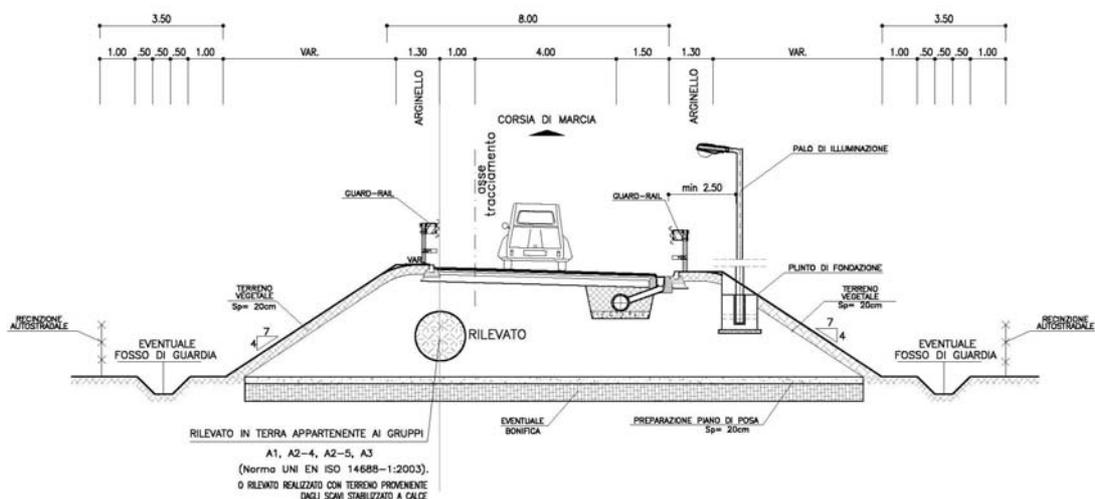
Sezione tipo rampa monodirezionale in rilevato
